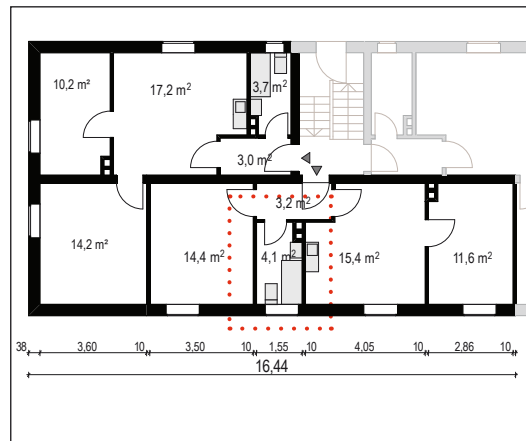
Beispielgrundriss Regensburg, Nibelungenstraße 4, EG
